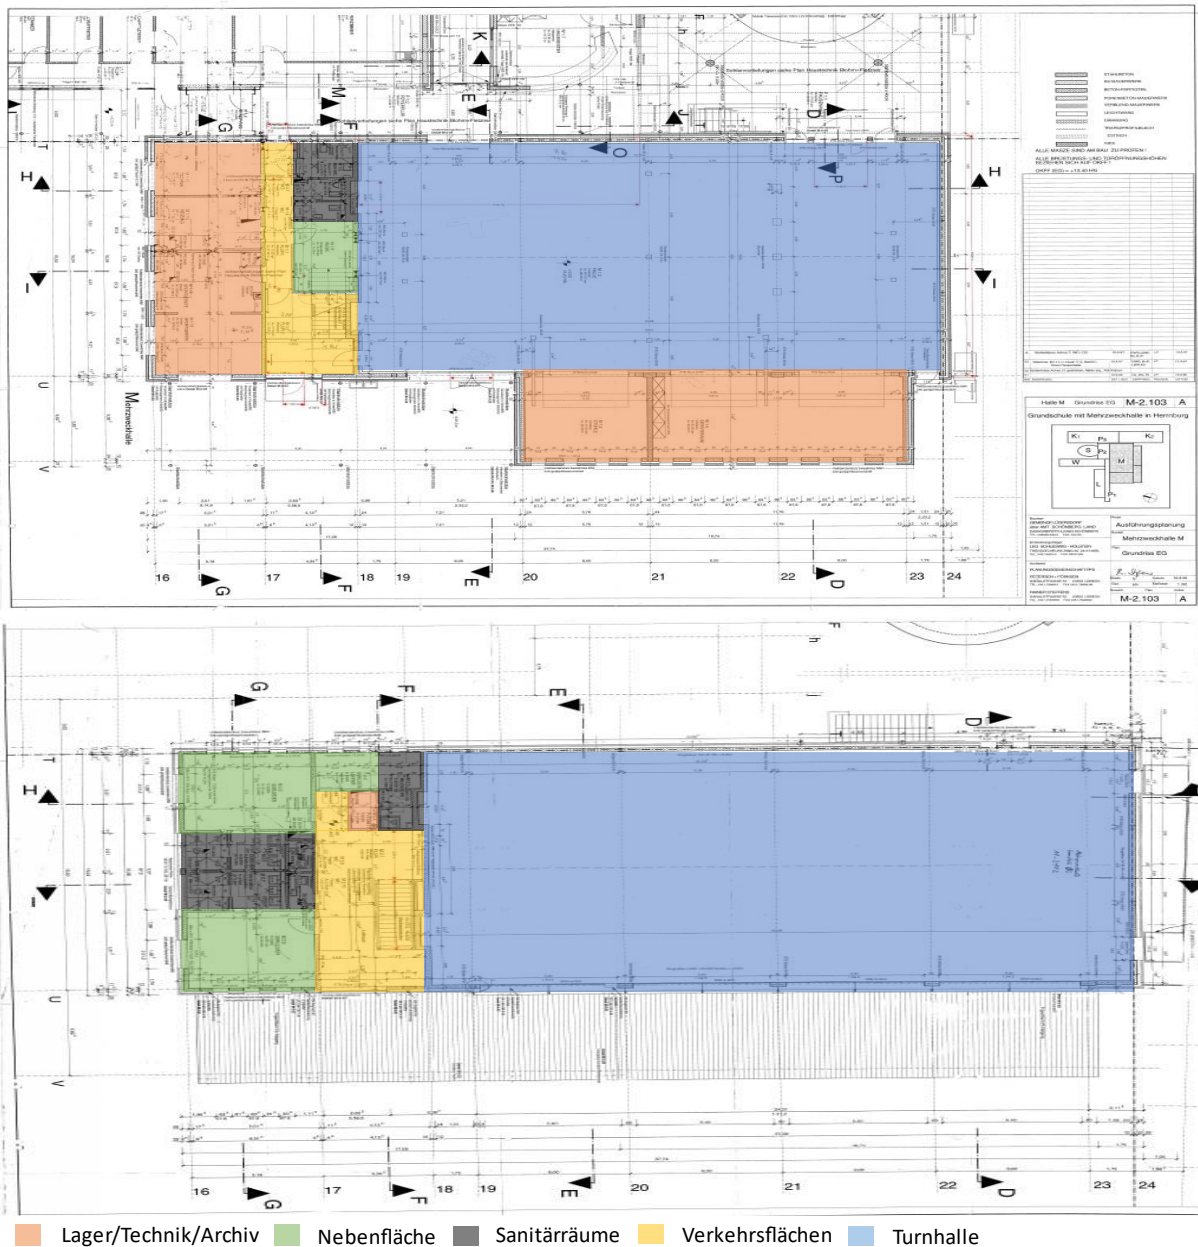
Zonierter Grundriss des untersuchten Gebäudes
